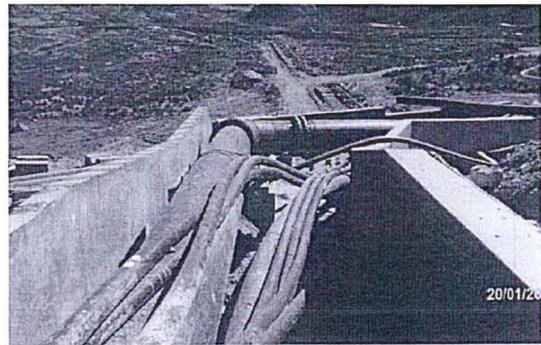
En las coordenadas E 0344397 y N 8780458 se culminó la construcción de la estructura de contención del relleno hidráulico
